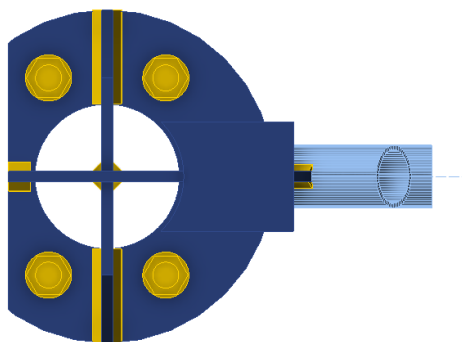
Розріз монтажної стики нижнього поясу просторового блоку ферми
